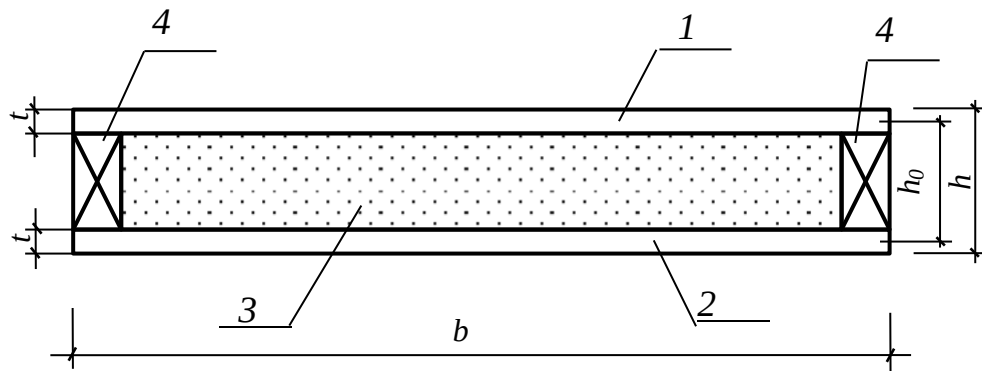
сечение трехслойной плиты покрытия с асбестоцементными обшивками: 1 – верхняя обшивка; 2 – нижняя обшивка; 3 – средний слой (пенопласт); 4 – обрамляющие бруски
